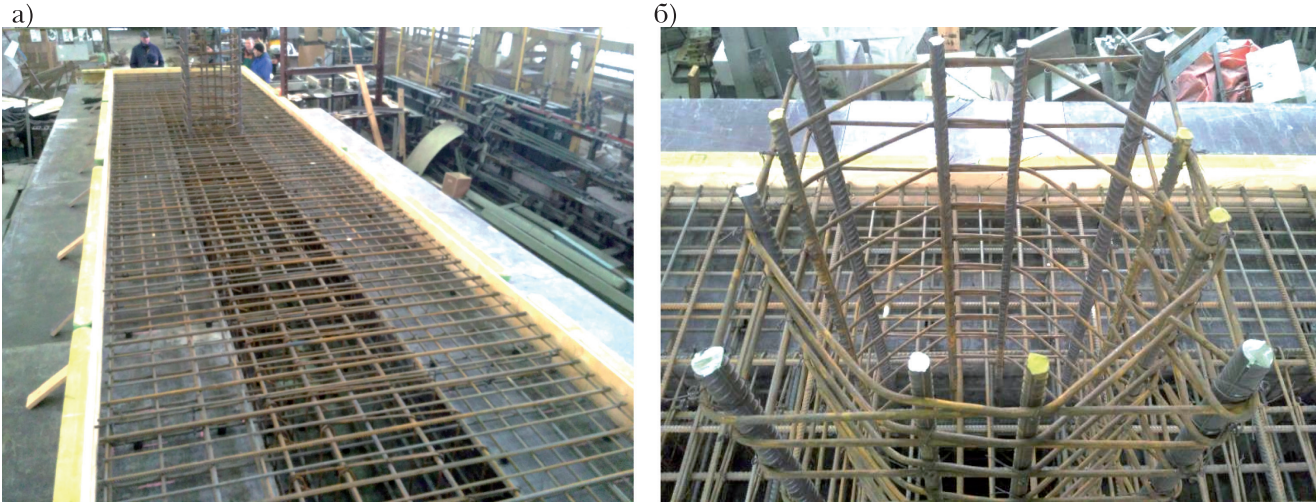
Армування зразка балки: а) армування полиці б) армування опори-колони
